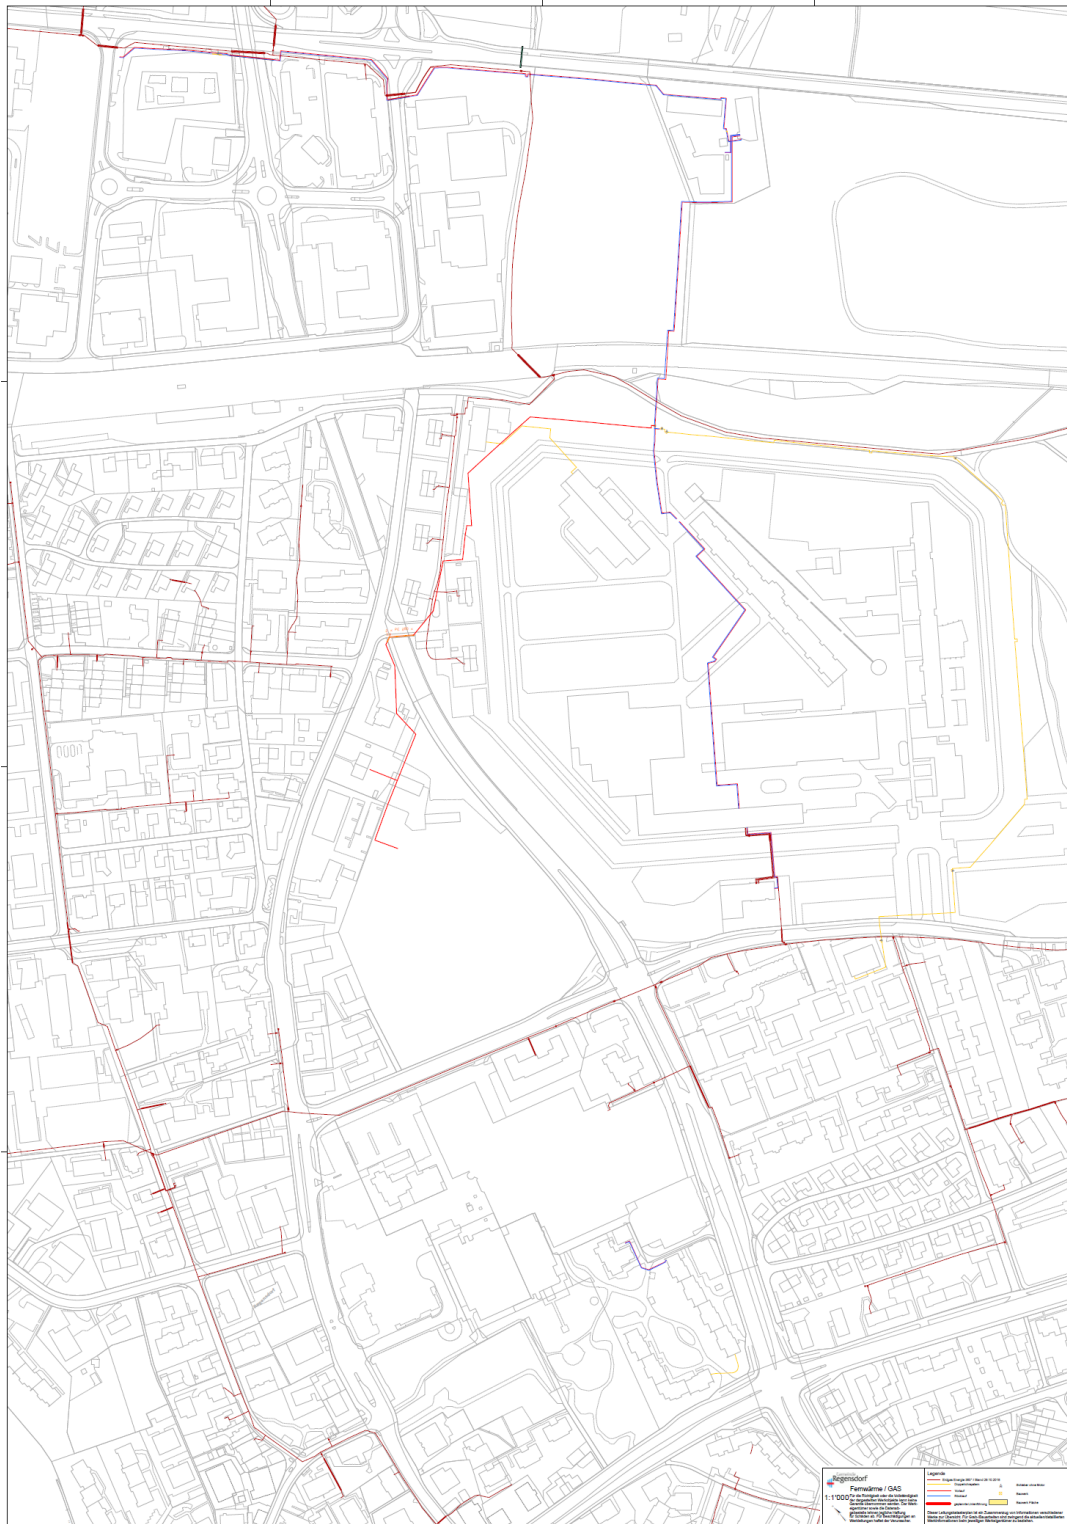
Leitungsplan Fernwärme und Gasnetz im Projektperimeter des Wärmeverbundes. Die Heizzentrale ist im Plan oben Mitte rechts zu sehen. (siehe Anhang A5.1 Leitungsplan Aecherliholz 181217)
